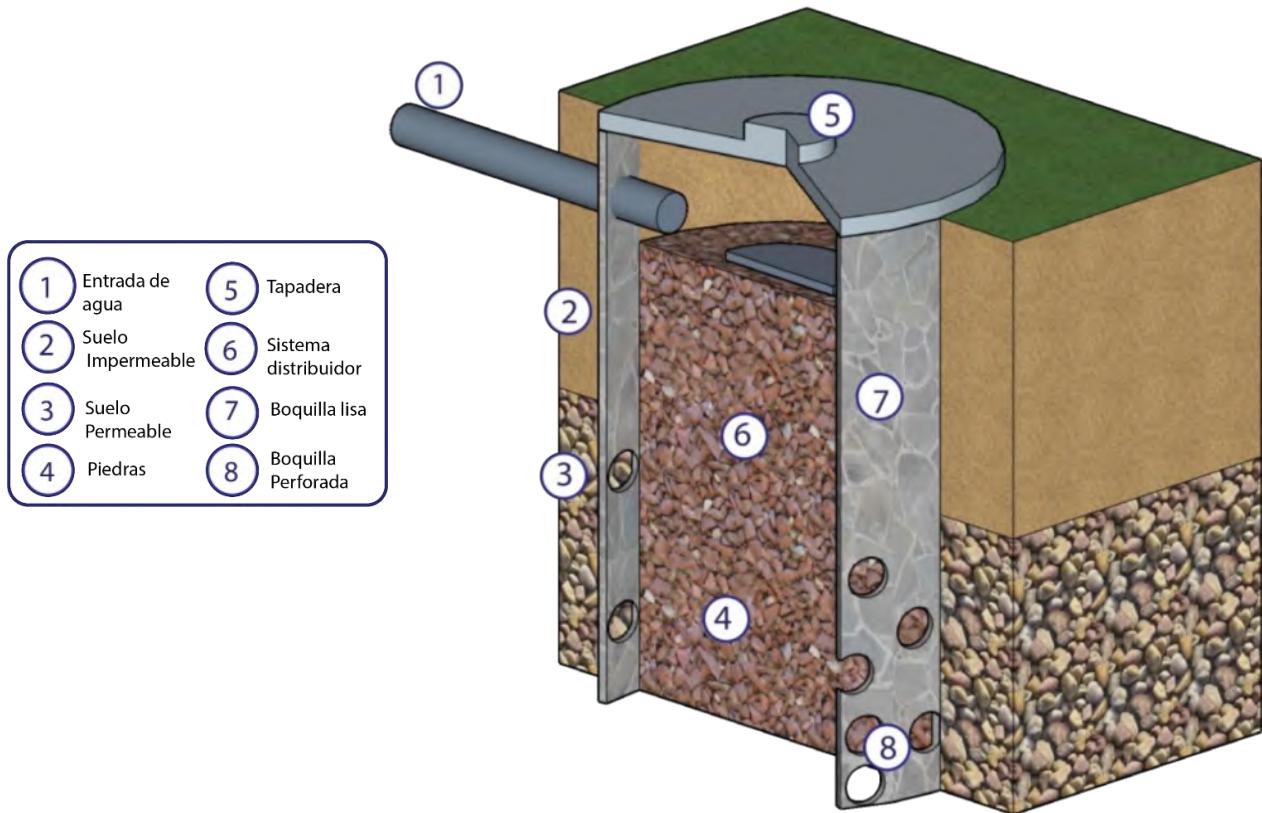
| Detalle de Pozo de absorción, elaboración propia
